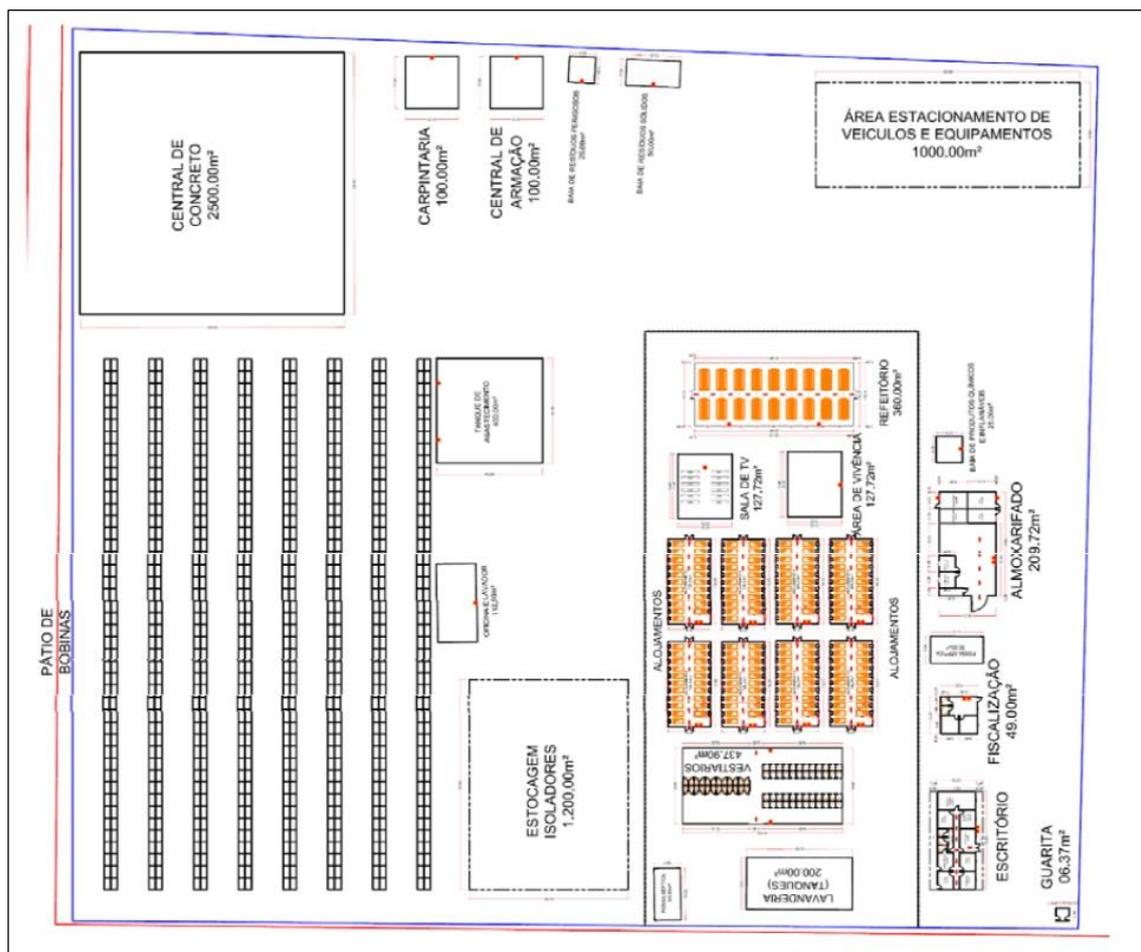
Arranjo básico para canteiro de obras para área de aproximadamente 5 ha.
